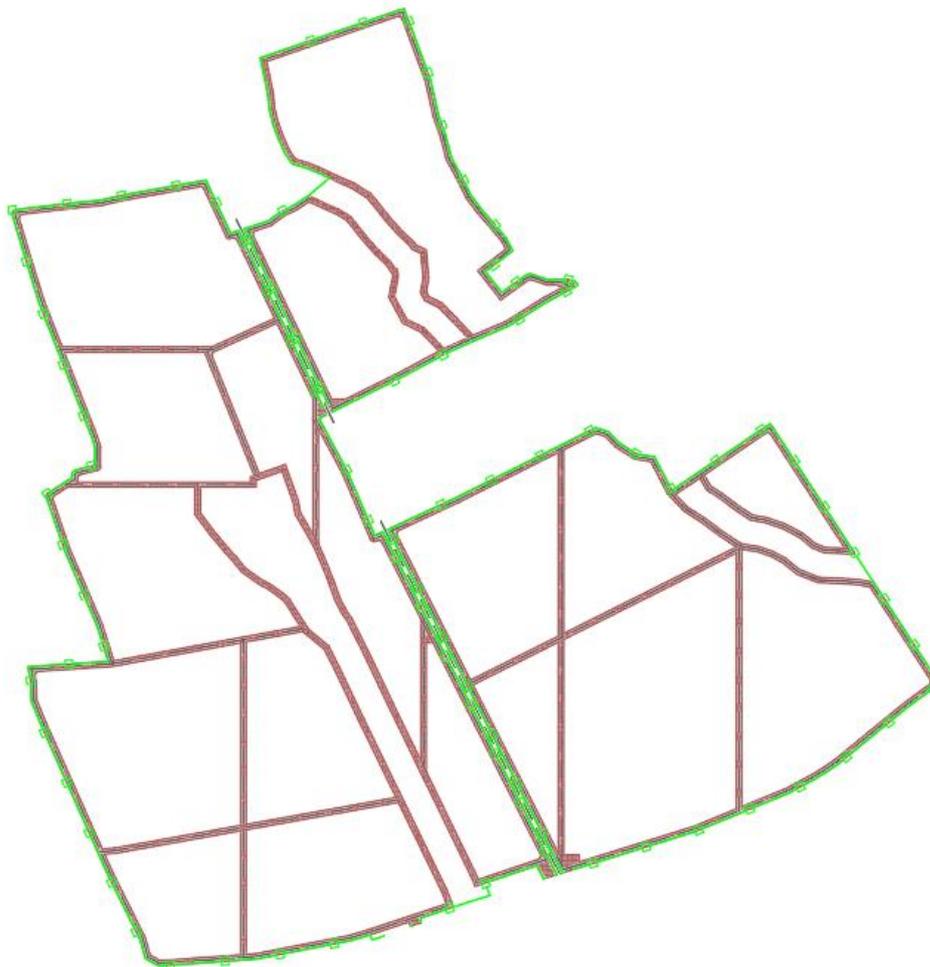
Planimetria viabilità interna al parco – Caltagirone
